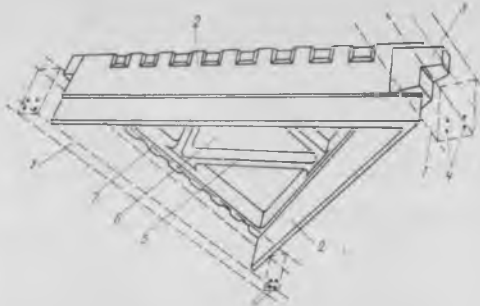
Конструкция треугольных ребристых плит размером 3×3 м для сборно-монолитных кессонных перекрытий
